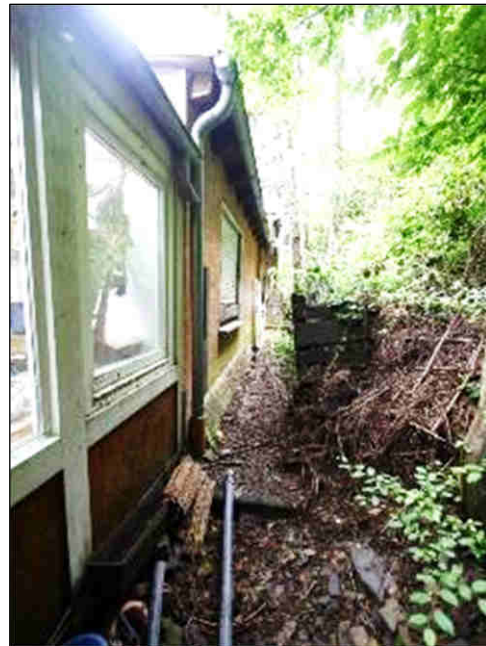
nicht genehmigte Anbauten an der Gebäuderückseite
